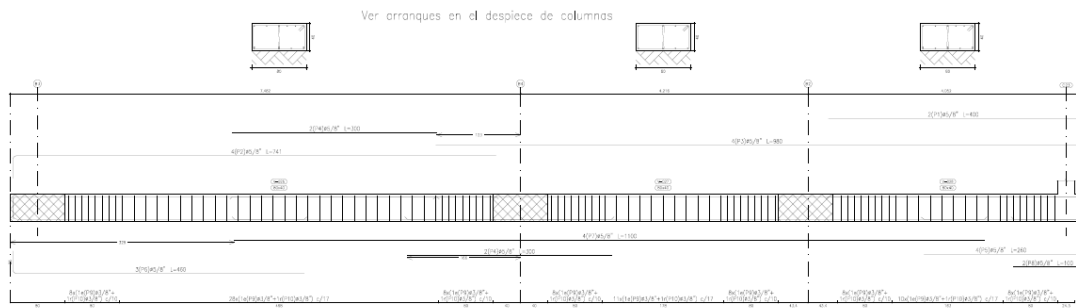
Despiece Pórtico 11. Colegio. CAJAMAG.
